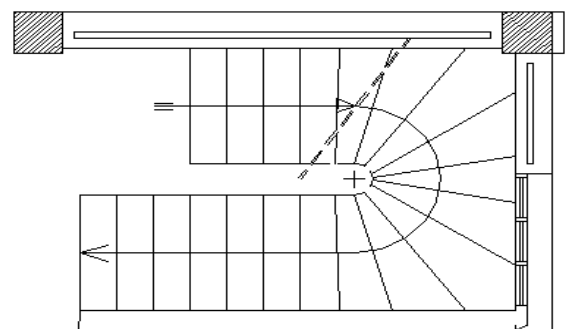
vue en plan de l'escalier balancé au niveau 2<sup>ème</sup> et 3<sup>ème</sup> étage
